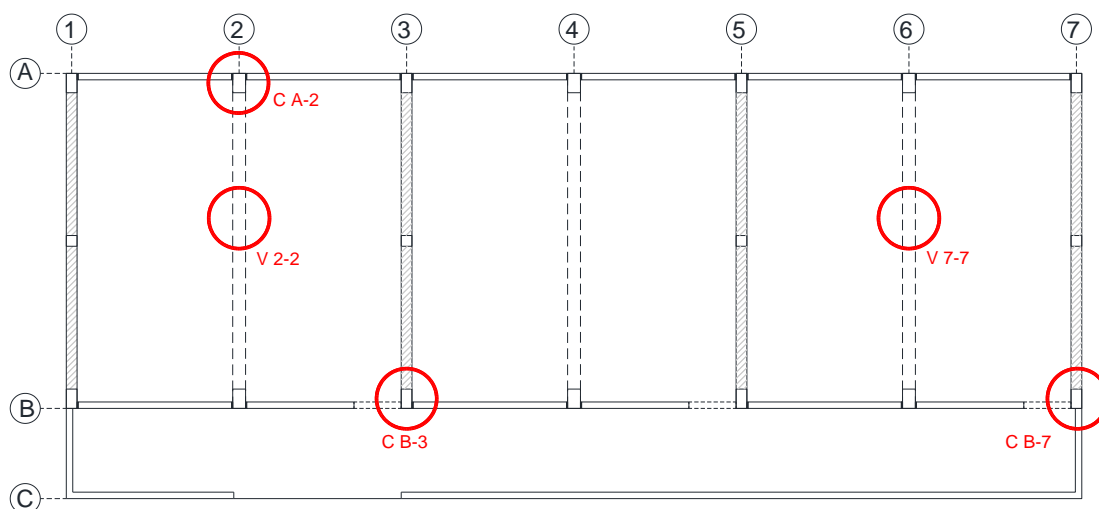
Elección de la viga y la columna para el ensayo. Fuente: Propia.
